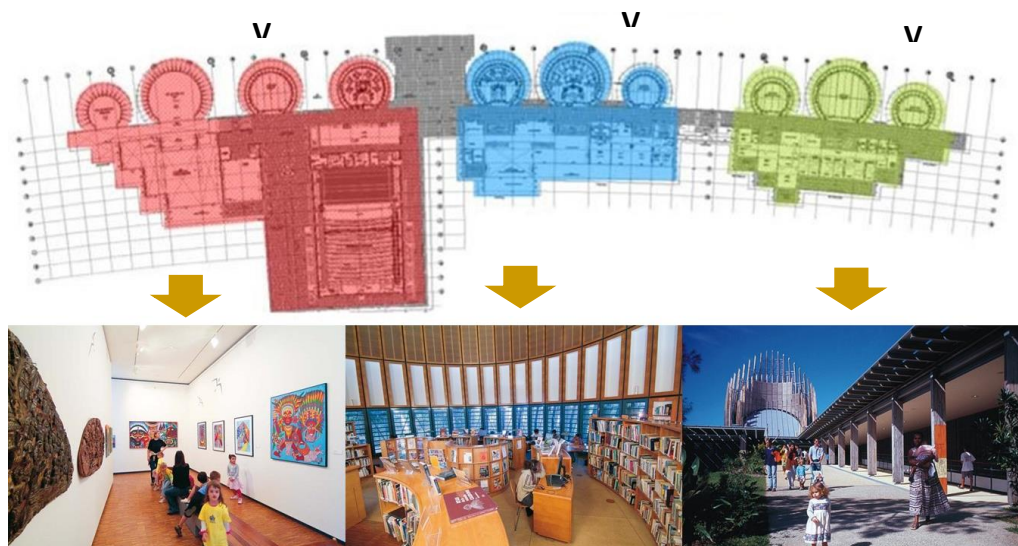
Vista de planta del centro cultural Jean Marie Tjibaou.
